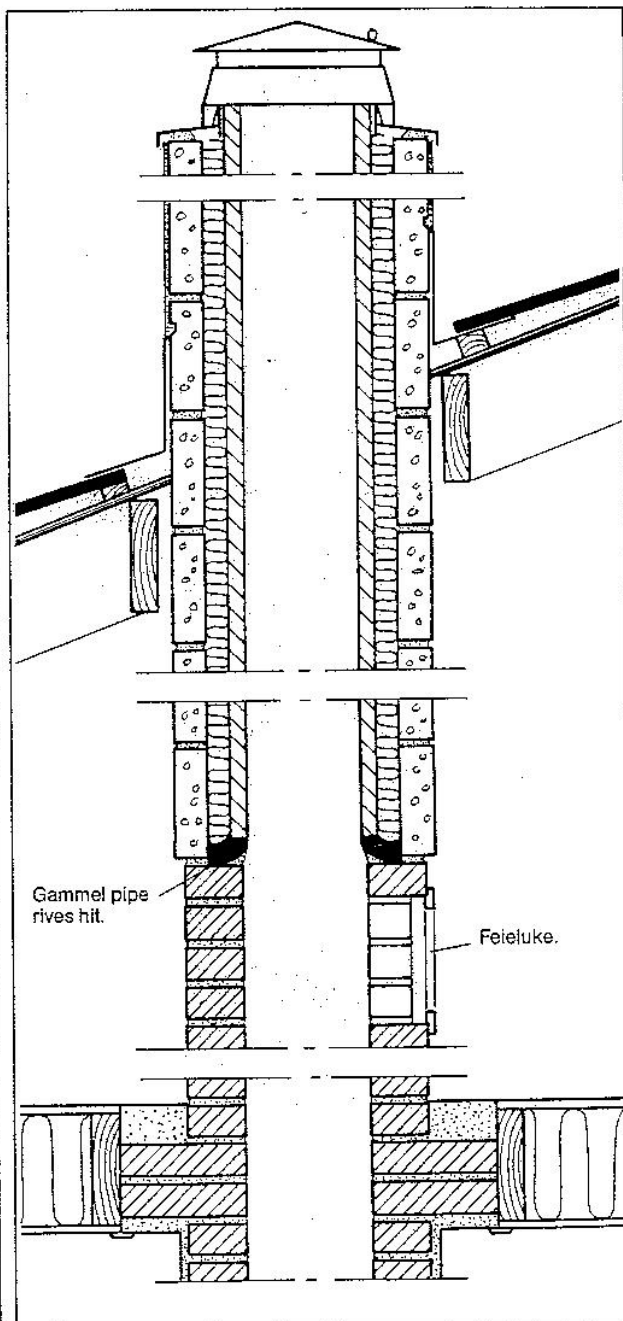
LECA pipe som isolert konstruksjon fra feieluke på loft.
